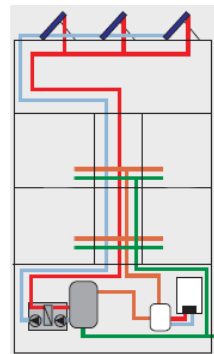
Panneaux solaires en toitures et production d'eau chaude en chaufferie rez-de-chaussée ou sous-sol.
